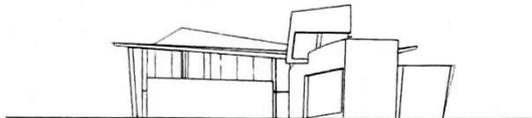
Zaha Hadid. *Posto de Bombeiros Vitra*. Fachada oeste, elevação, 1990-4.
